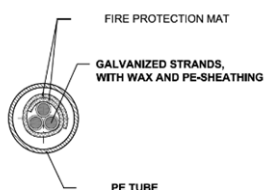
Detalle protección ignífuga tirantes con mantas enrolladas
